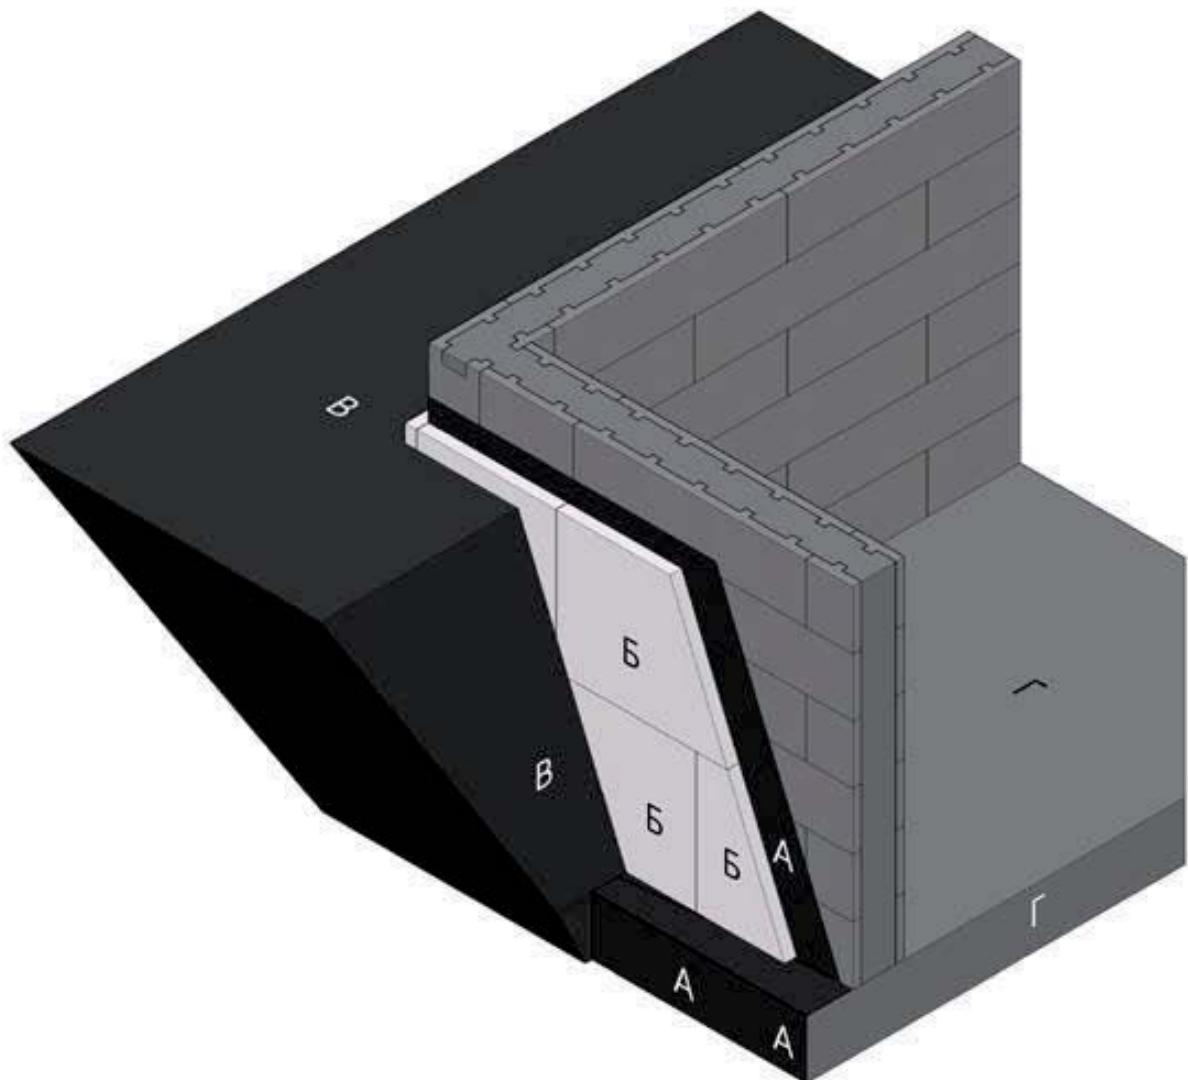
Возведение подпорных стен для подвального или цокольного этажа
